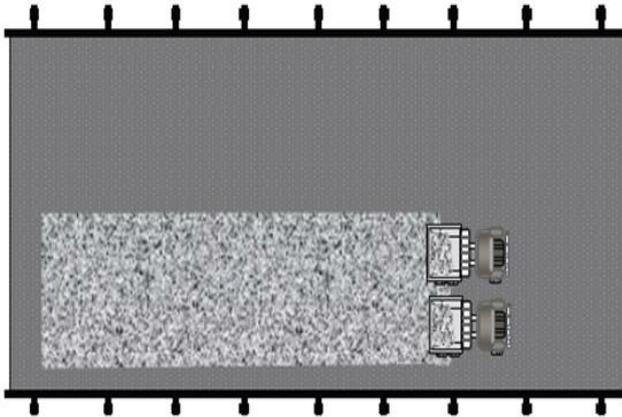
Descarga del concreto a lo largo de tramo a pavimentar.
